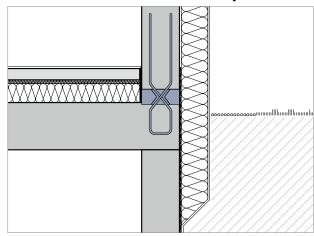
Schöck Sconnex® type W pour mur extérieur et isolation sur la dalle
